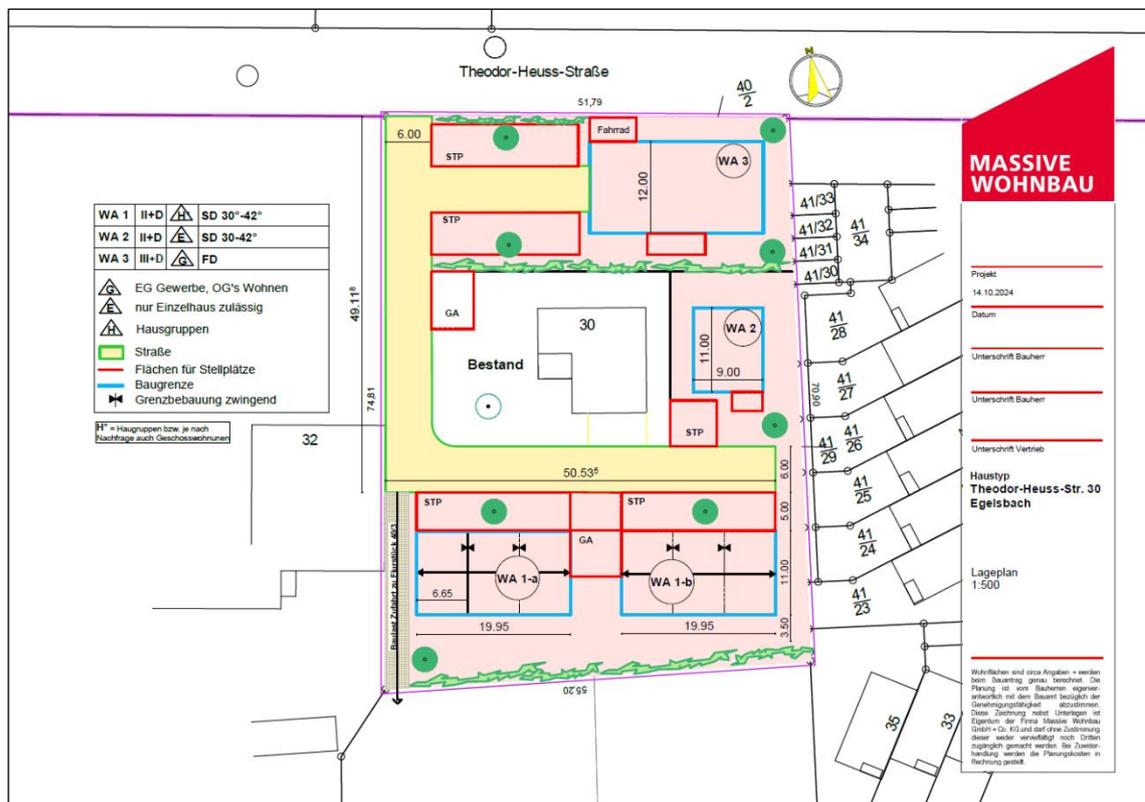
Vorhaben- und Erschließungsplan – Lageplan. (Quelle: Massive Wohnbau, Stand 14.10.2024)
